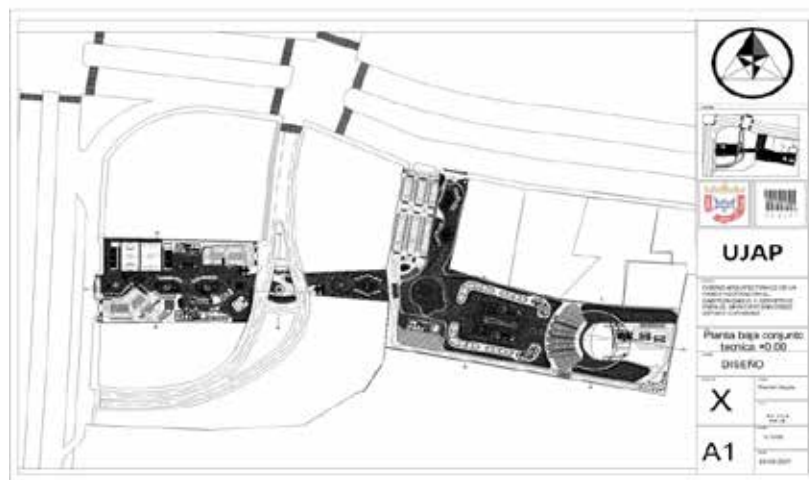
Planta baja conjunto nivel ± 0.15 . El autor (2021)
